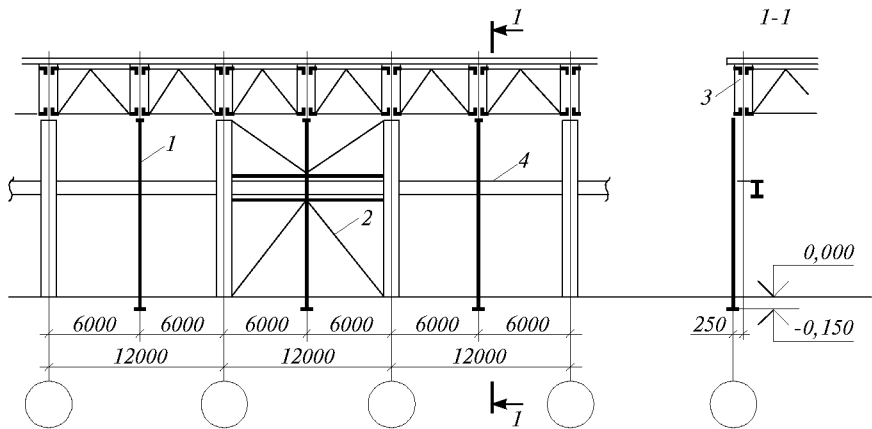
Продольный фахверк в здании с мостовыми кранами при шаге ферм 6 м
